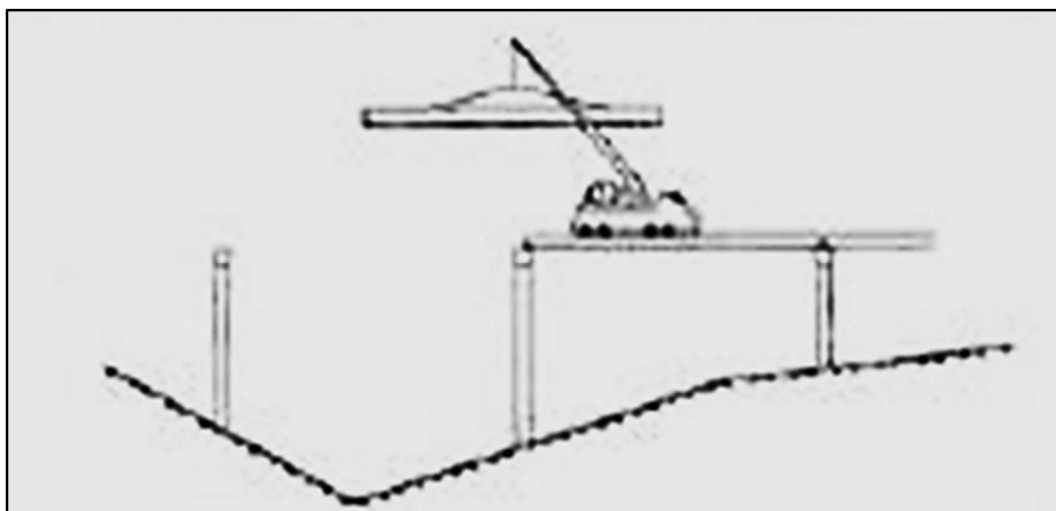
Construcción del vano mediante grúas apoyado en la estructura
